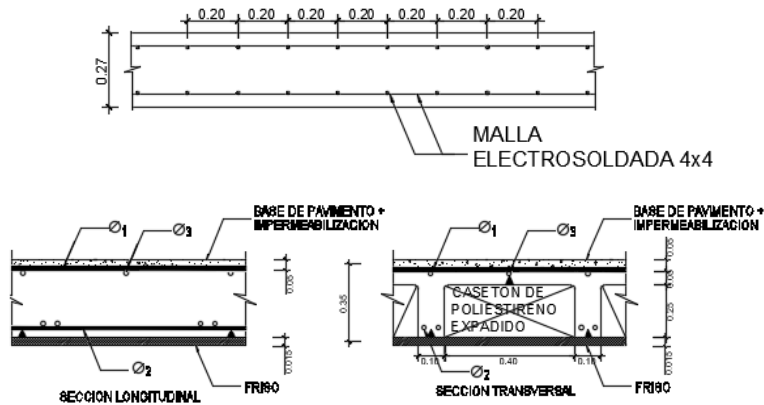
Detalle de losa de piso y losa de techo. *La Autora*, (2017)
